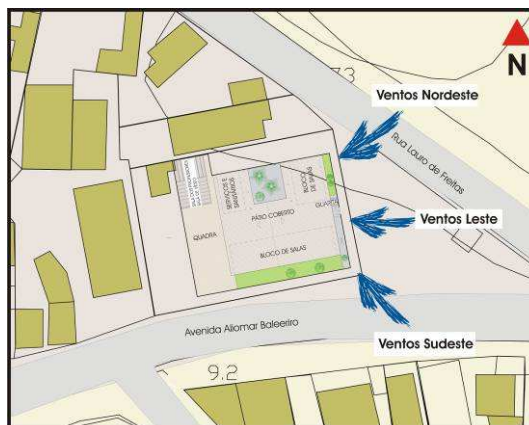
Planta do lote do terreno da escola indicando orientação dos ventos predominantes para Salvador.
